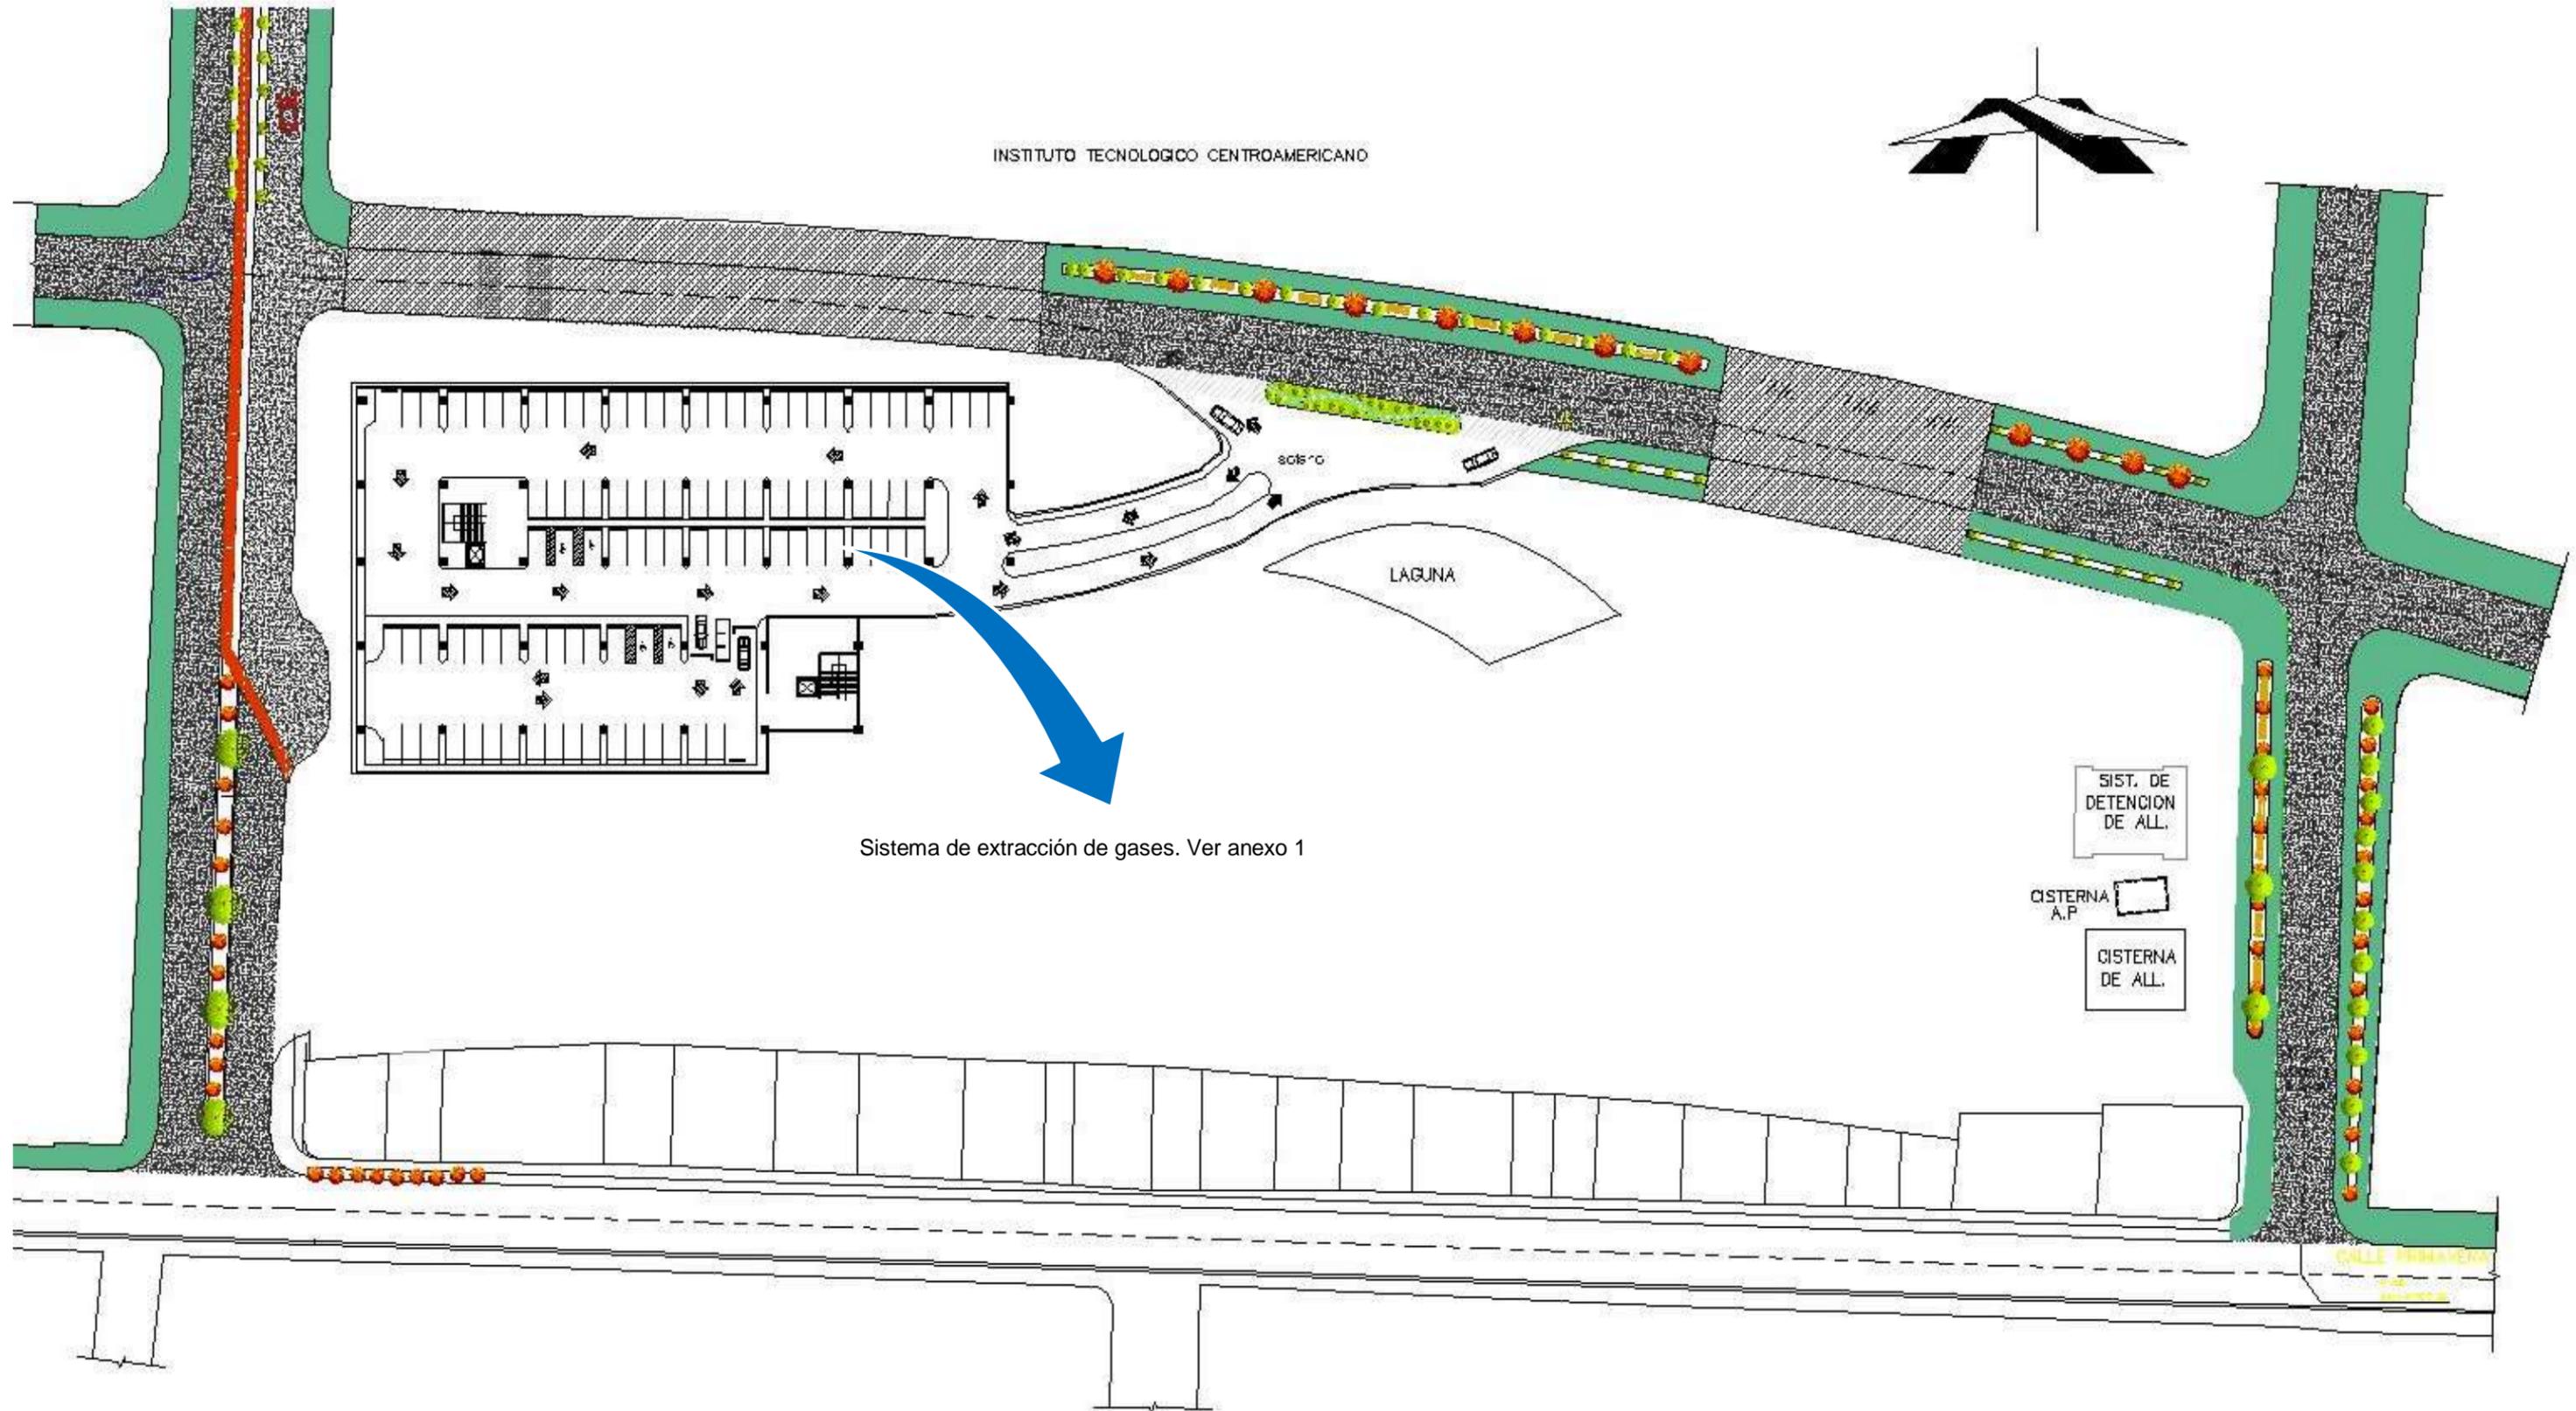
Planta de estacionamiento sótano, sin escala, fuente de elaboración propia.
